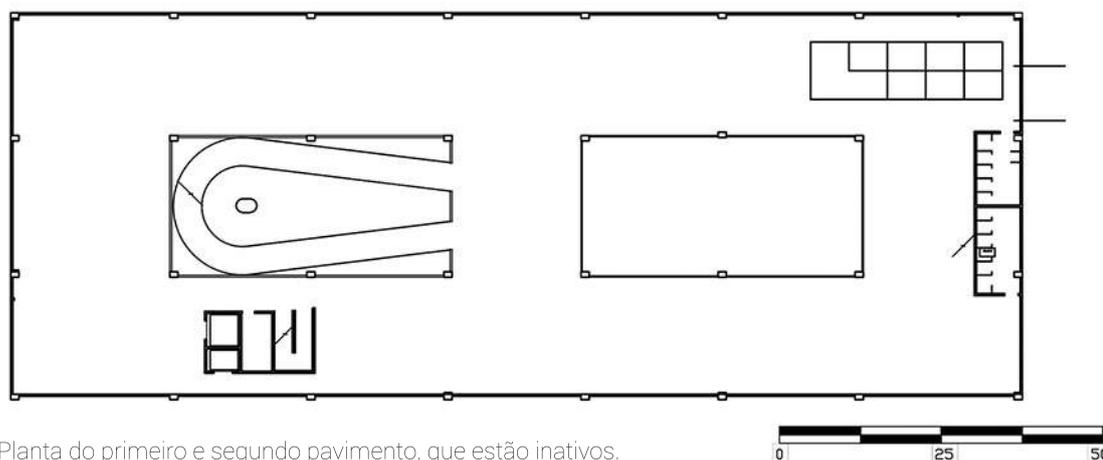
Planta do primeiro e segundo pavimento, que estão inativos.
